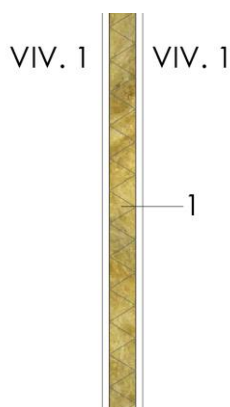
Detalle de tabiquería de distribución interior en las viviendas (sección vertical) con lana mineral en Málaga. Fuente: Elaboración propia
